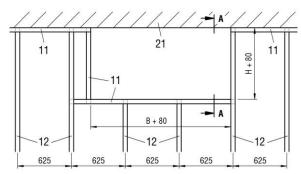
Metallständerwerk mit erforderlichen Auswechslungen (Einbau direkt unter massiver Decke mit "Einlage Mineralwolle)
